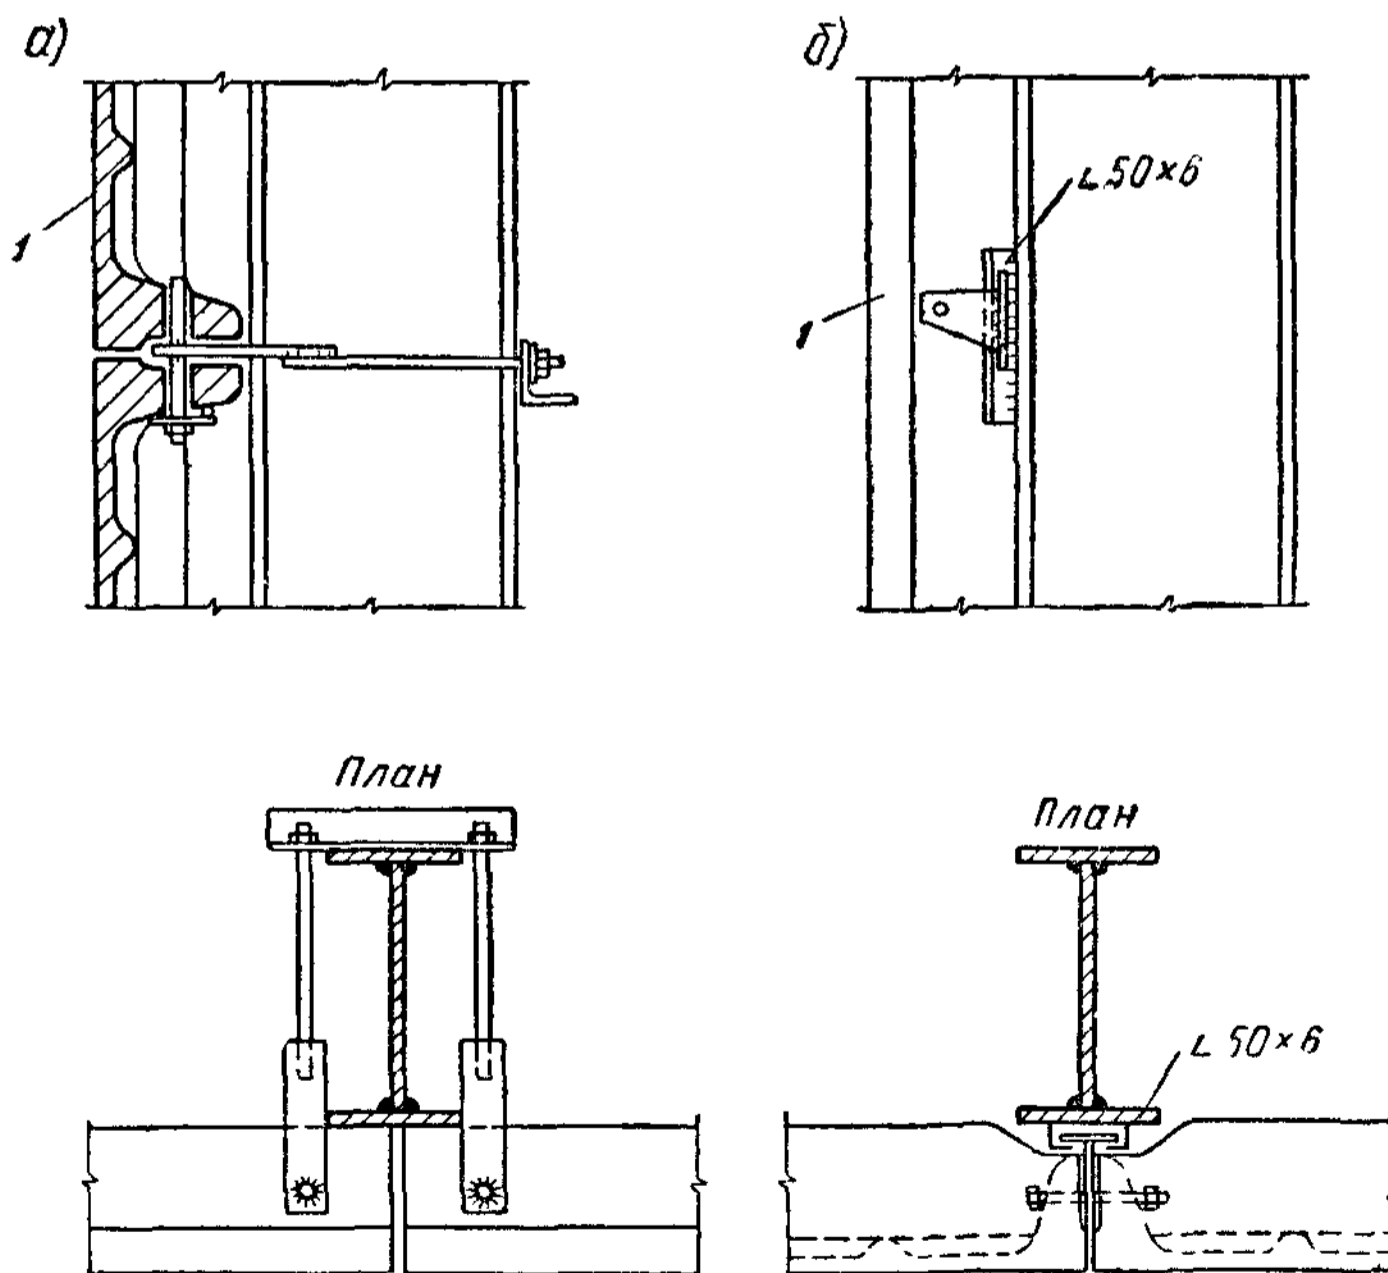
Прикрепление железобетонных часторебристых панелей к колоннам
